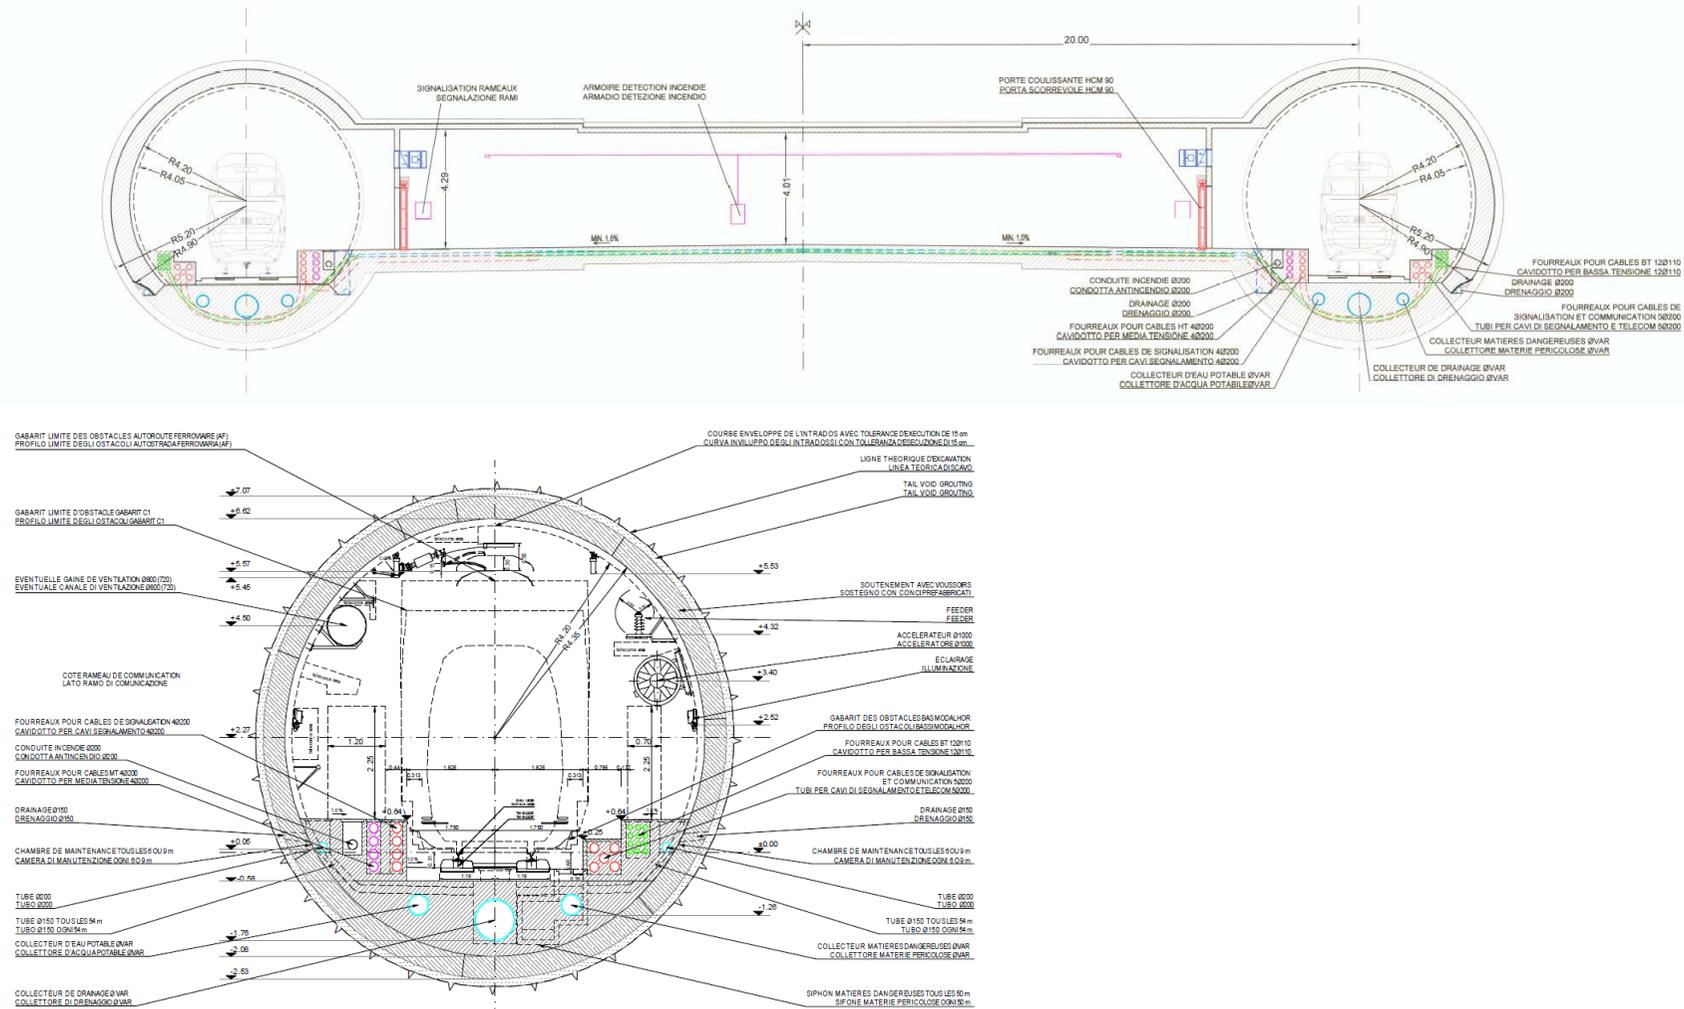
Sezione tunnel in corrispondenza del bypass – particolare canna – Fonte Progetto preliminare LTF
